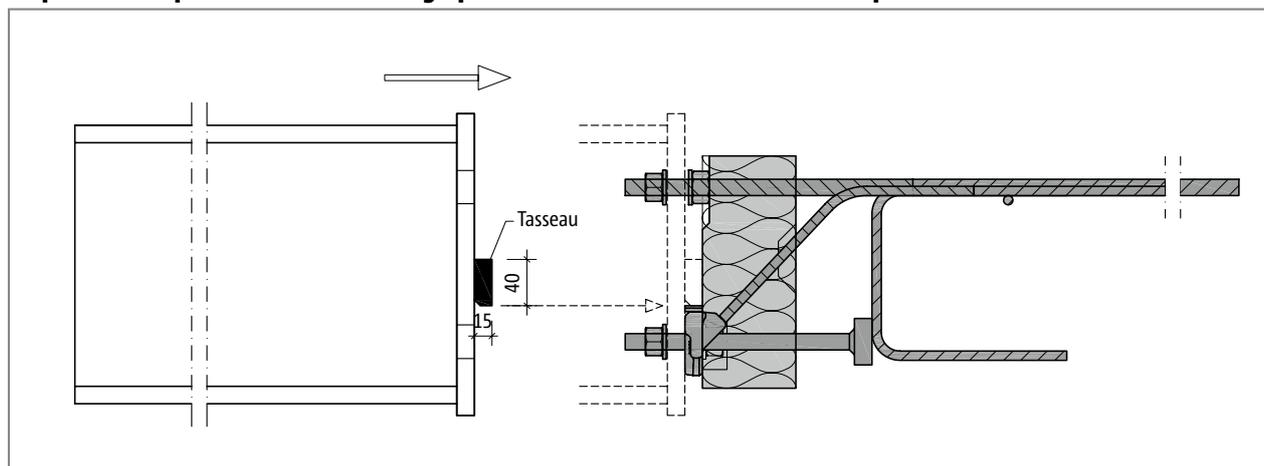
Schöck Isokorb® T type SK : montage de la poutre en acier
